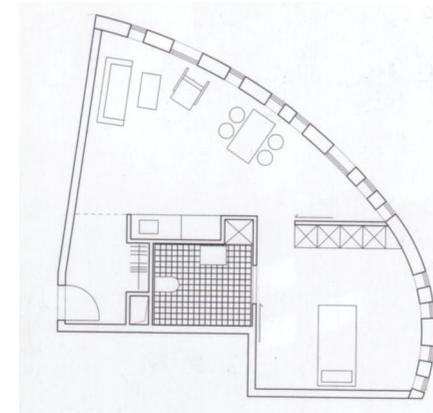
Grundriss Apartmenttyp A M 1:200
